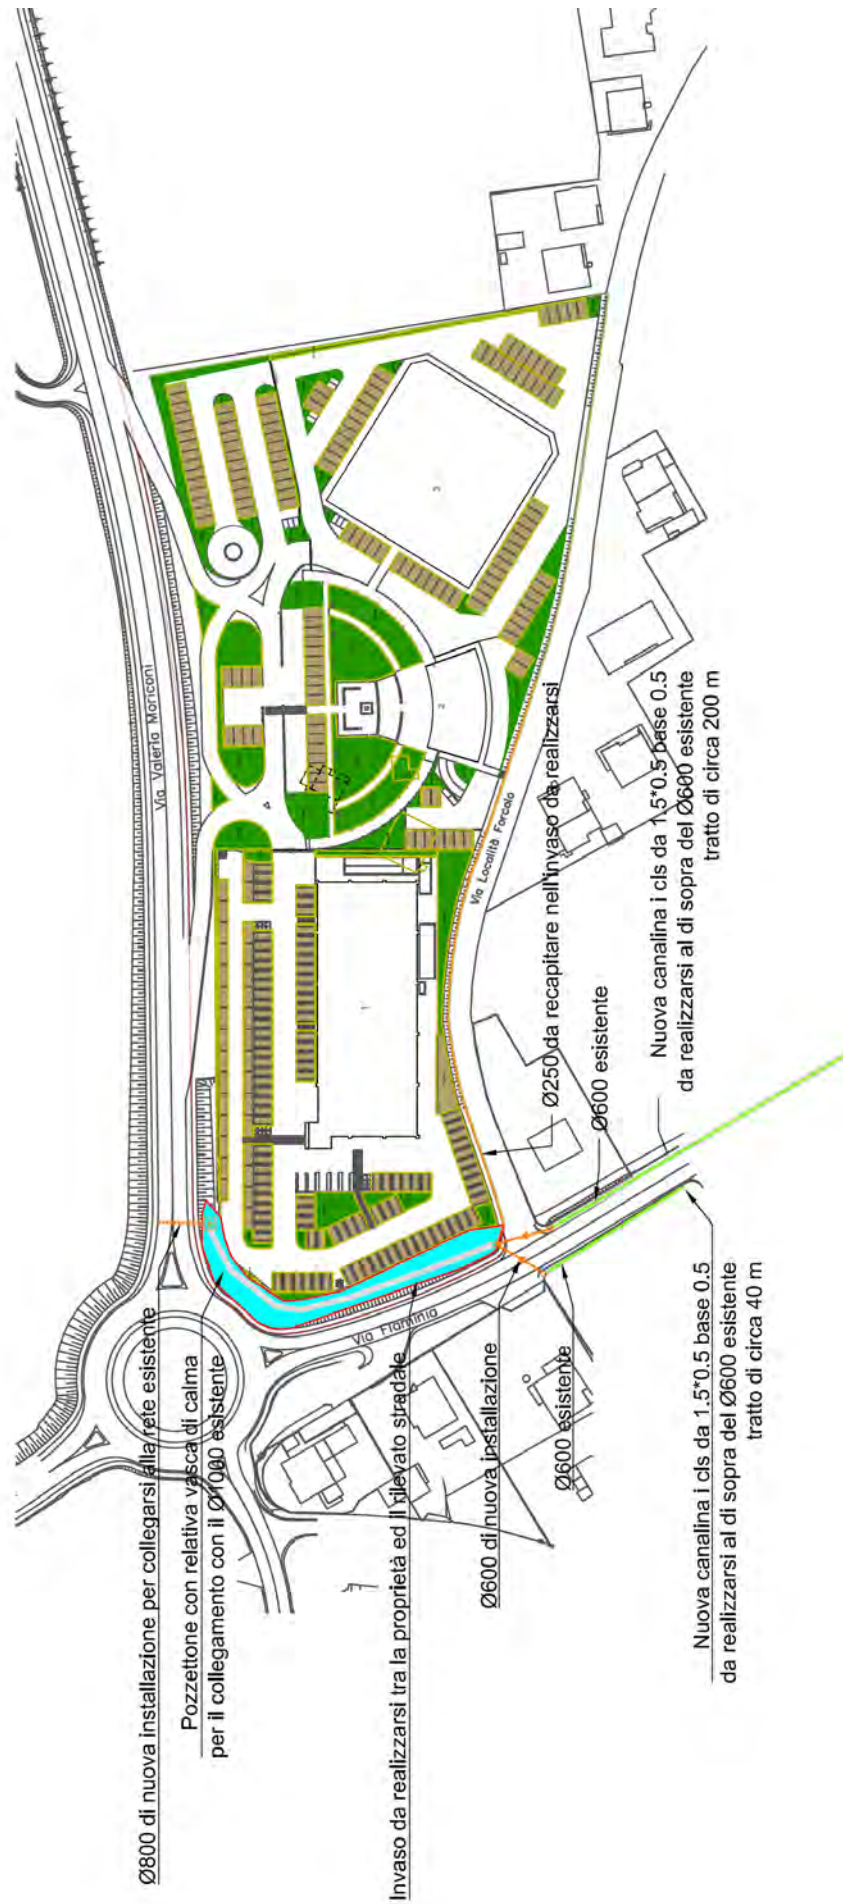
Schema planimetrico con interventi di mitigazione proposti.
